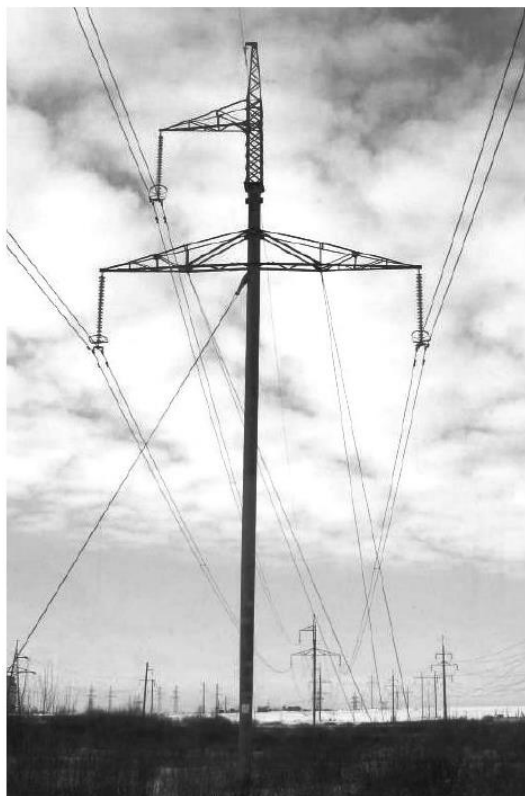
Залізобетонна проміжна опора ПЛ 330 кВ
